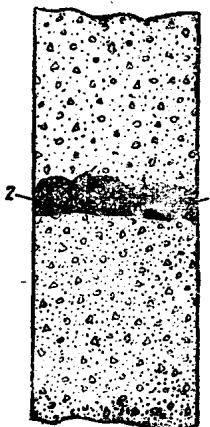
鋼筋混凝土柱由于在灌筑混凝土时落入雪花而形成的裂縫
